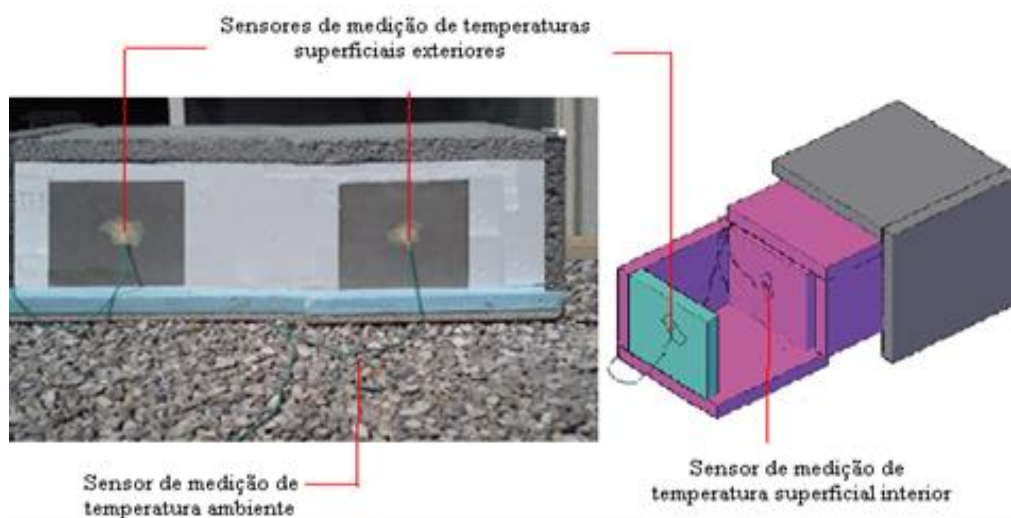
Pormenor construtivo das células de teste e localização dos sensores de medição
